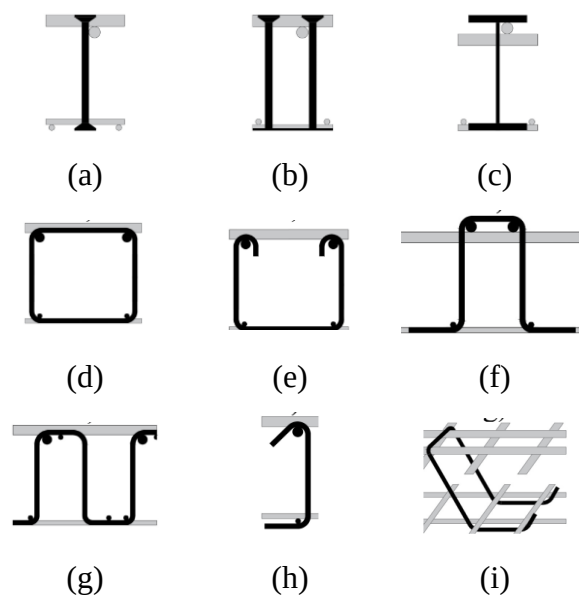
Armaduras de cisalhamento utilizadas nas análises (adaptado de Pereira Filho, 2021).
